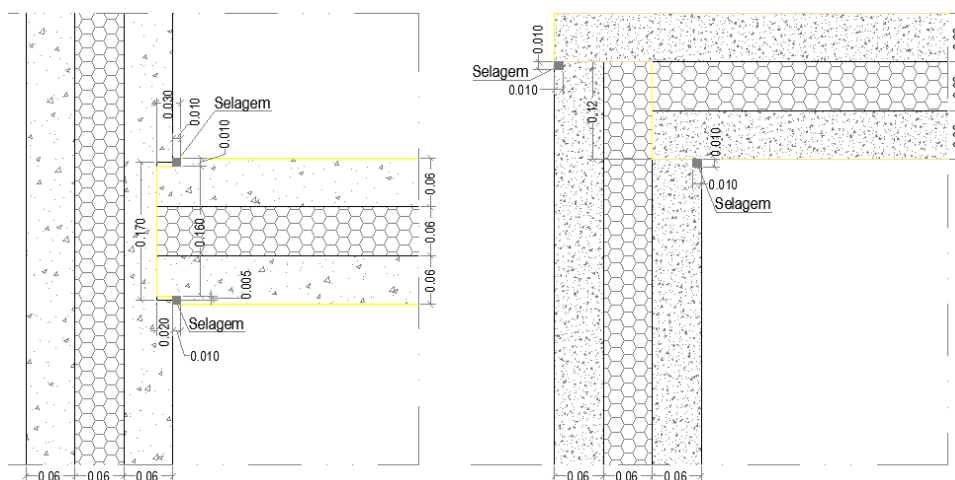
Corte em planta com os diferentes tipos de ligação entre painéis.
